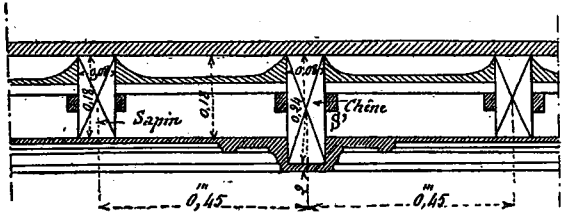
Coupe suivant GH du plan (fig. 317).
